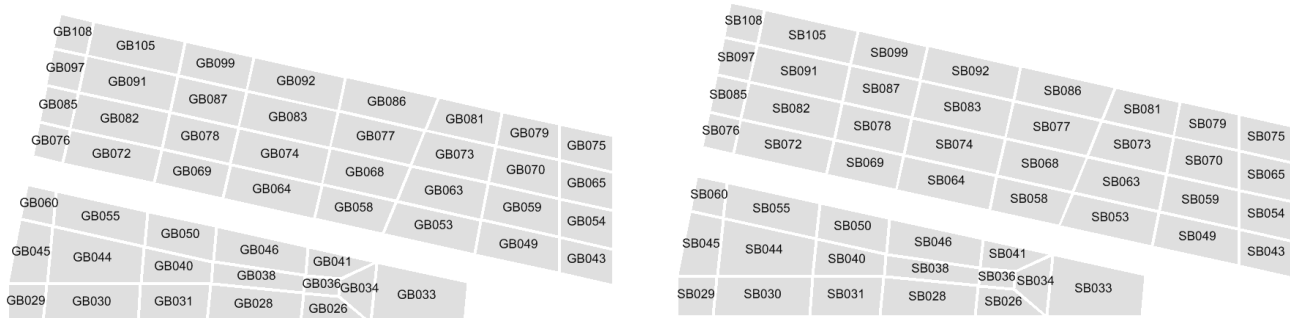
Nomenclatura elementi orizzontali verificati, fondazione (sx), elevazione (dx)
